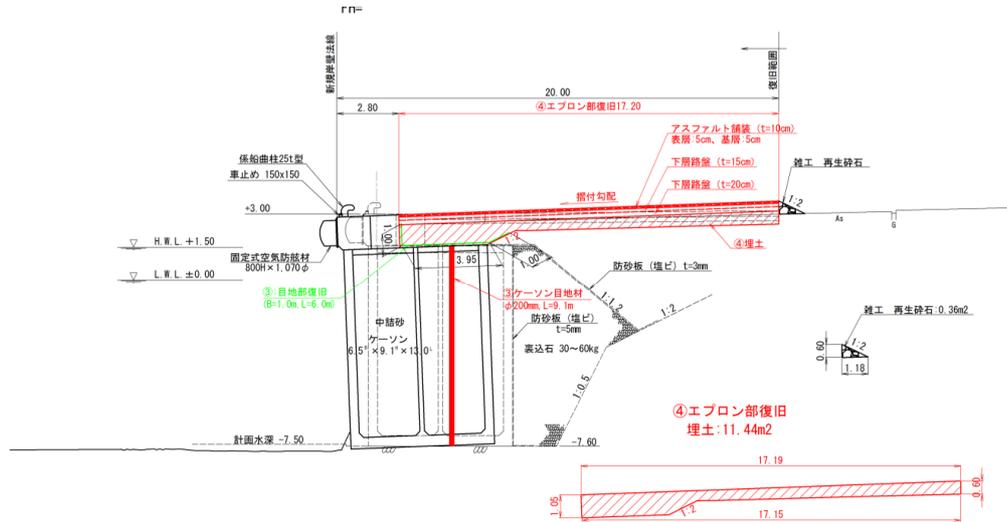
No.7 日立港区_第2ふ頭地区 2-D 岸壁 (-7.5m) の断面図 No.3 (復旧後)
